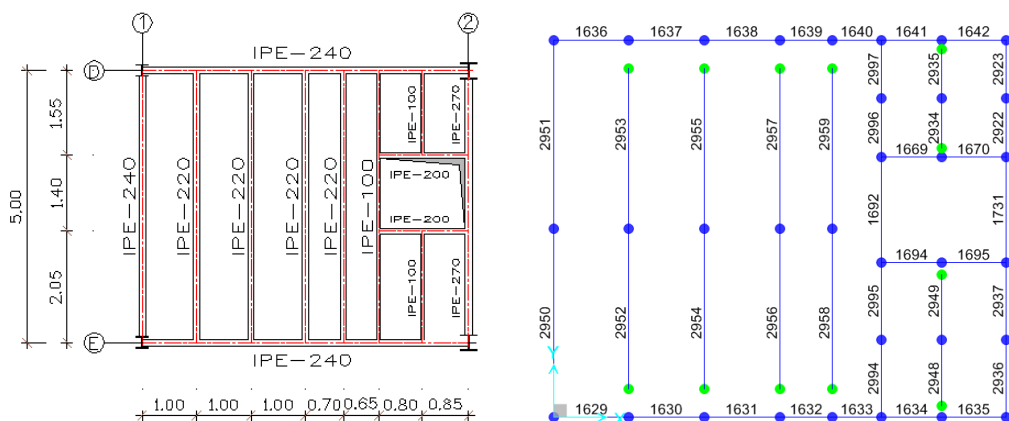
Planta com a Geometria e Identificação das Vigas Interiores do Piso 1 dos Alinhamentos 1 e 2.
